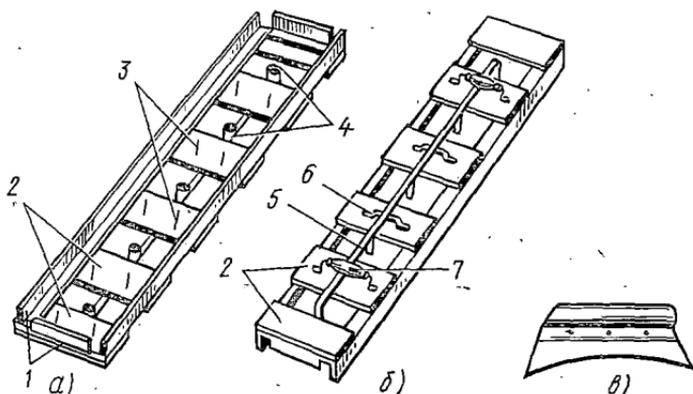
Пакетный шаблон для укладки пяти плиток: а, б — нижняя и верхняя стороны шаблона, в — шпатель-скребок; 1 — рама из уголков, 2 — пластинки, связывающие уголки, 3 — шпильки-фиксаторы, 4 — толкатели, 5 — направляющий стержень с толкателем, 6 — пластинчатая пружина, 7 — ручка
